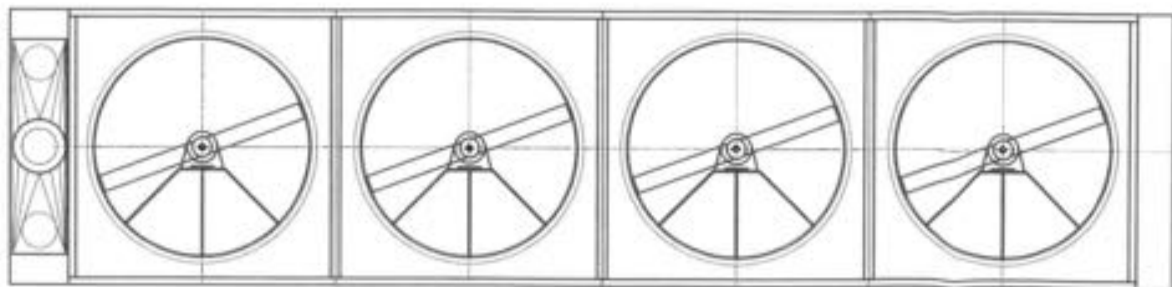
schema planimetrico aerocondensatore, marca "Carrera Impianti" - modello 4800.
